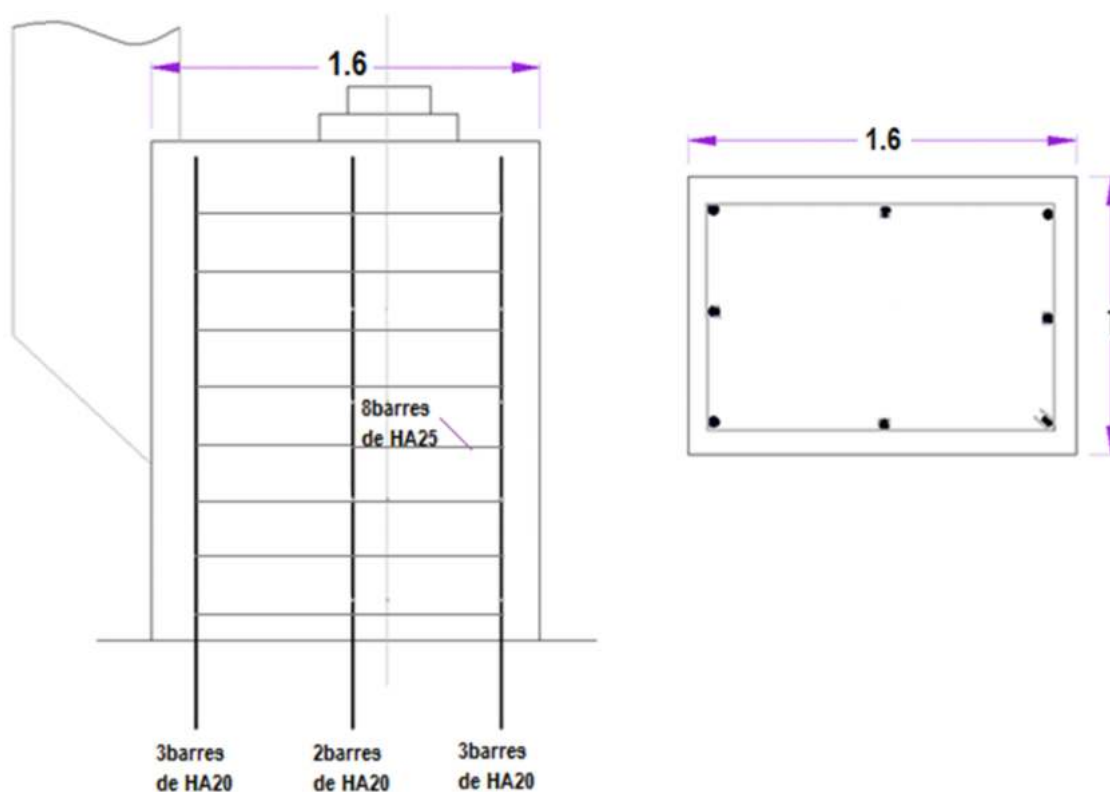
ferrailage du mur frontal sur 1 ml
